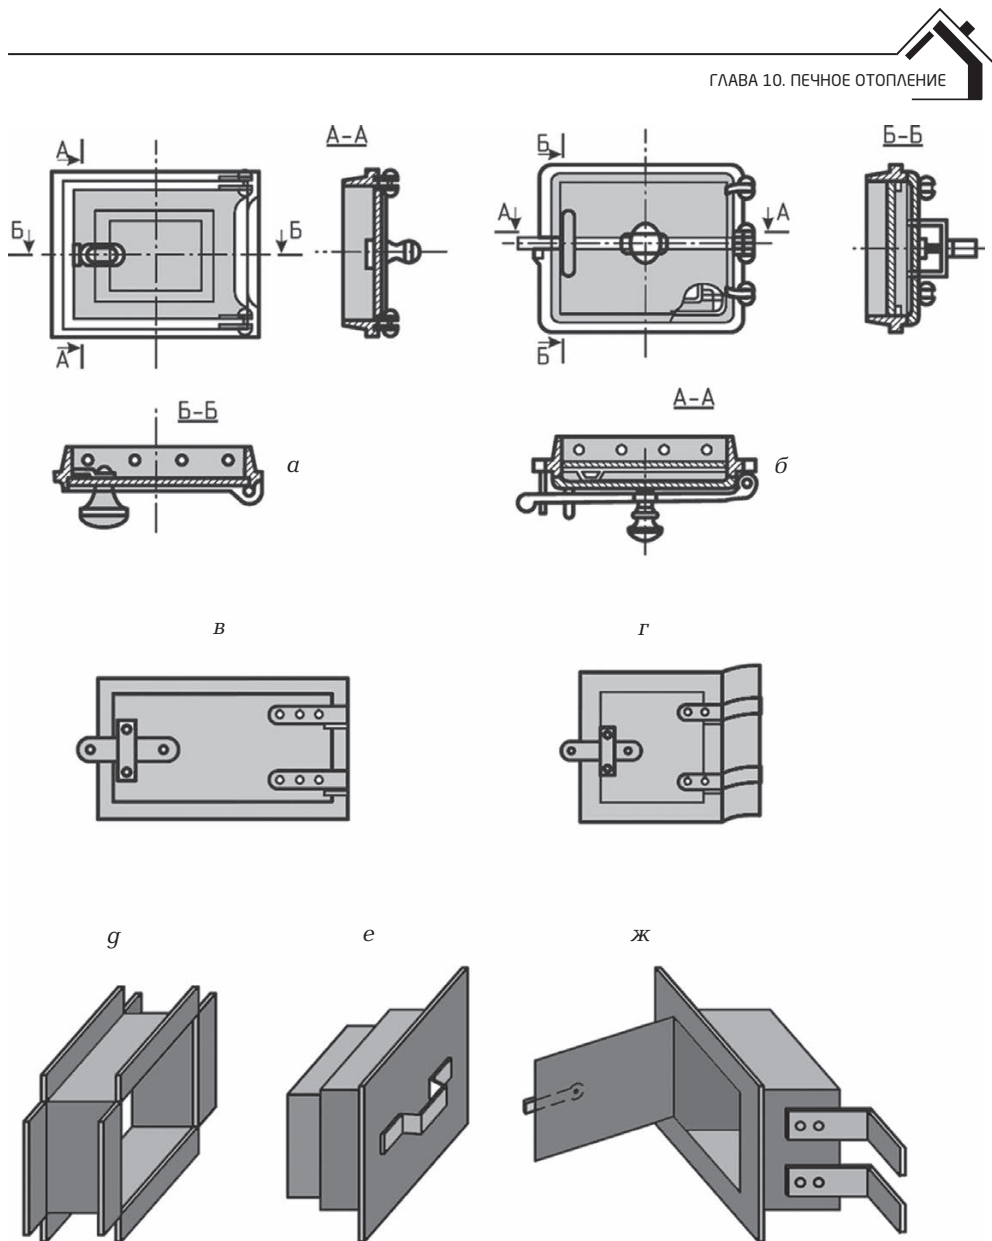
Печные приборы: а — обыкновенная дверка; б — герметичная дверка; в и г — простые стальные дверки и полу дверки; д — чистка из кровельной стали; е — коробка с вставленным в нее кирпичом; ж — крепление рамок дверок лапками
